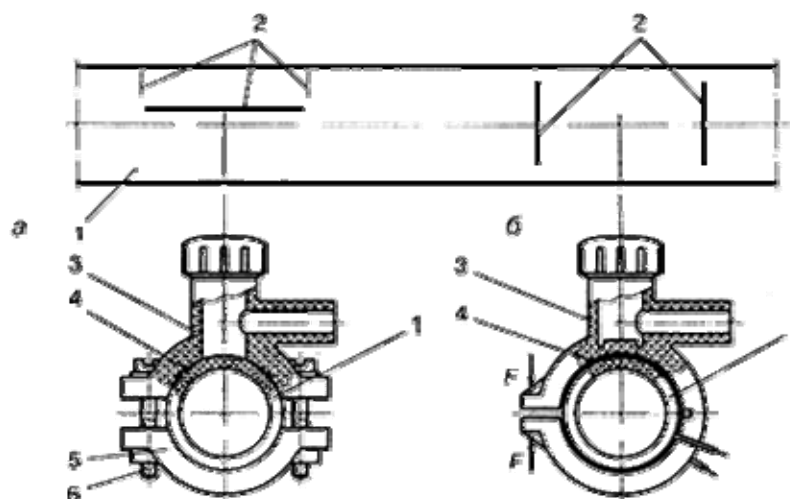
Схемы приварки отводов с закладными нагревательными элементами к полиэтиленовым трубам
